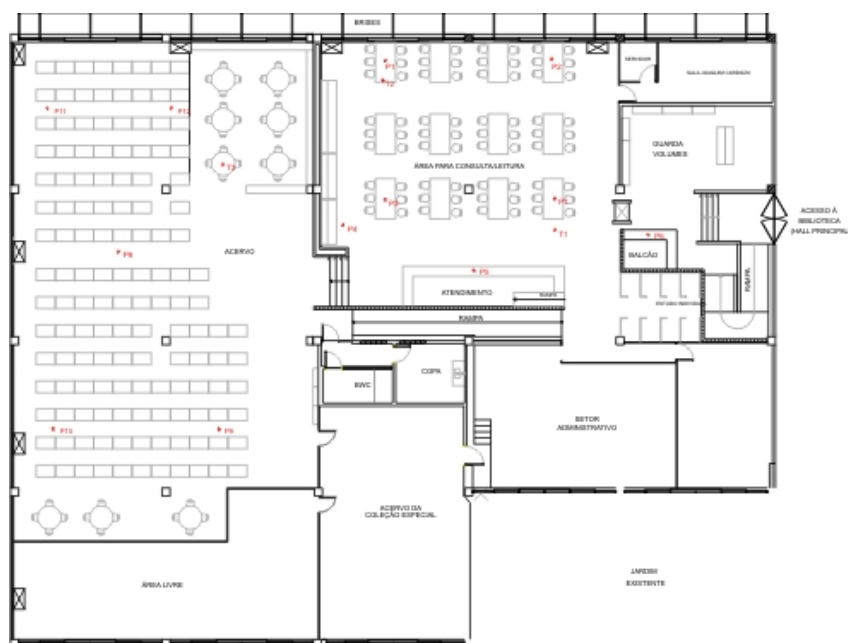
Planta baixa da biblioteca com a indicação dos pontos de medição
